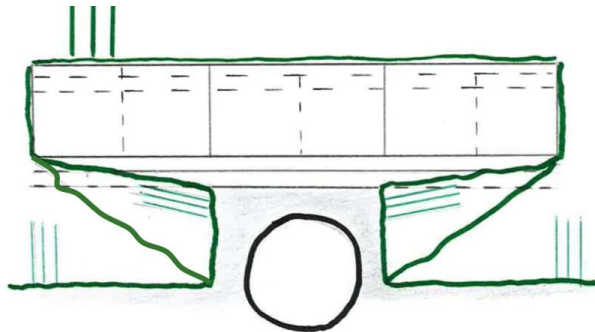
Schemaskizze der Stützmauer Grundriss
